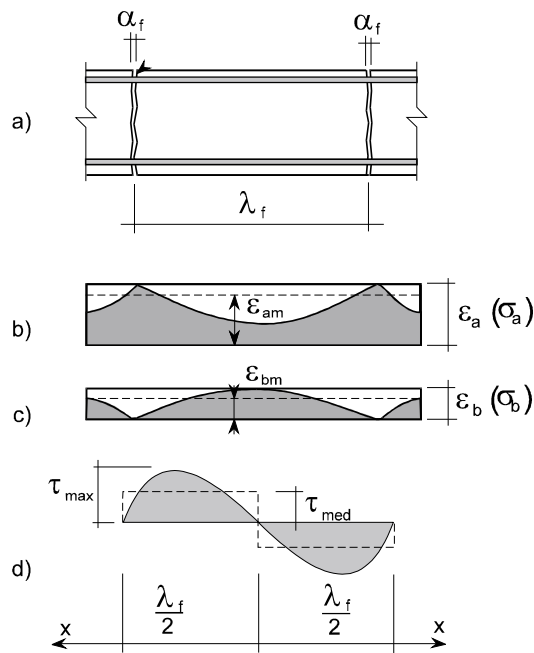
Diagrame de deformării și de eforturi într-un element de beton armat fisurat
